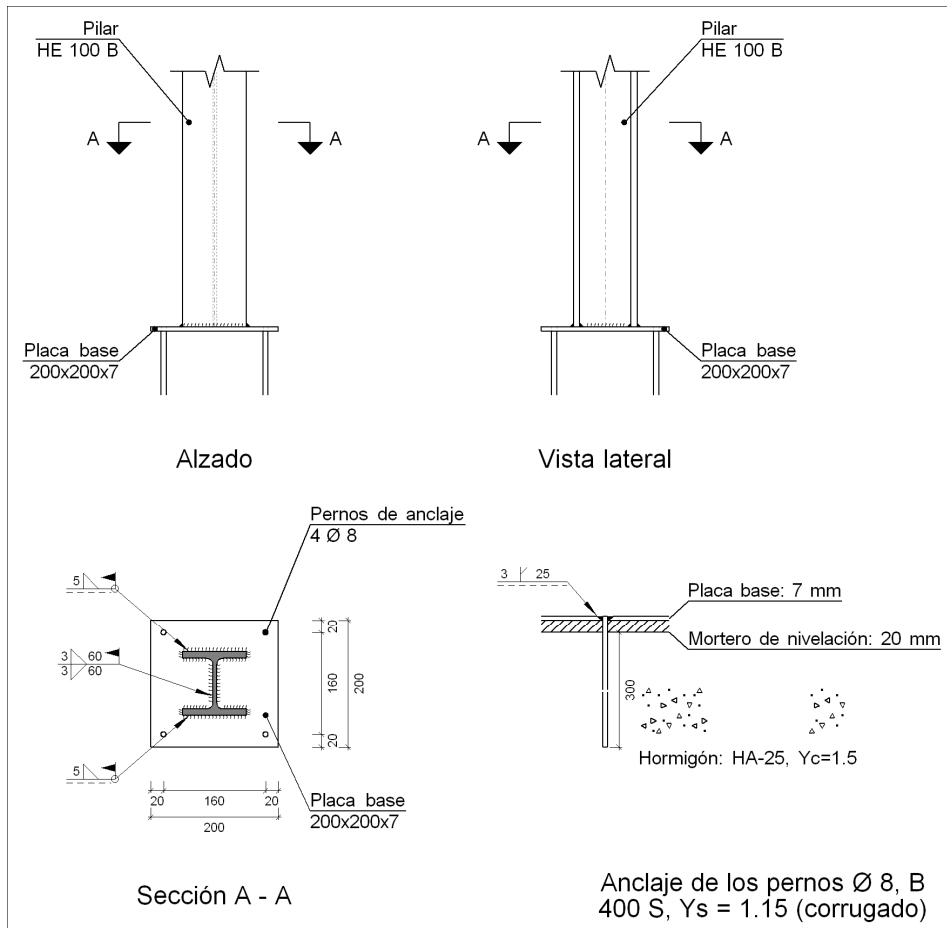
Detalle de los pernos de anclaje de la estructura superior de las escaleras
